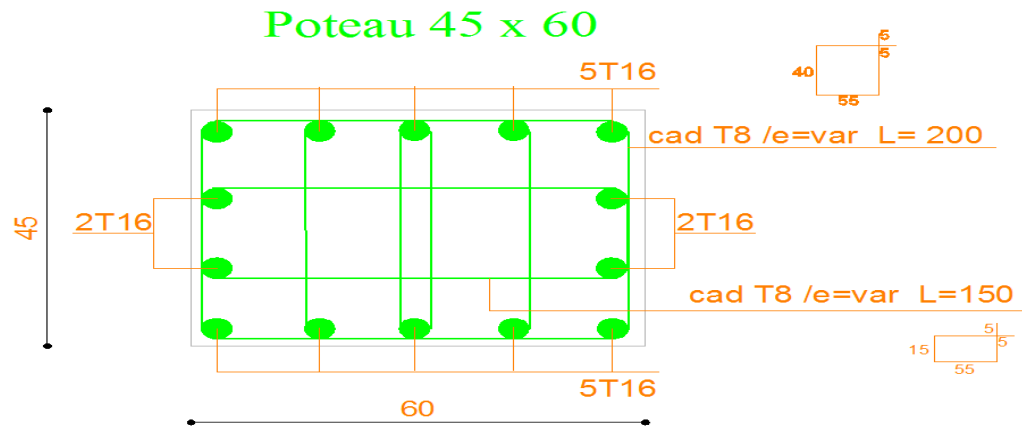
Schéma de ferrailage des poteaux 45x60.
